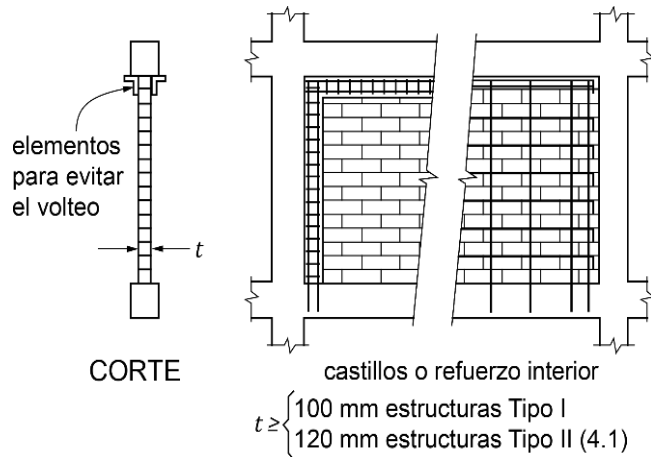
Ejemplos esquemáticos de detallado de muros diafragma
